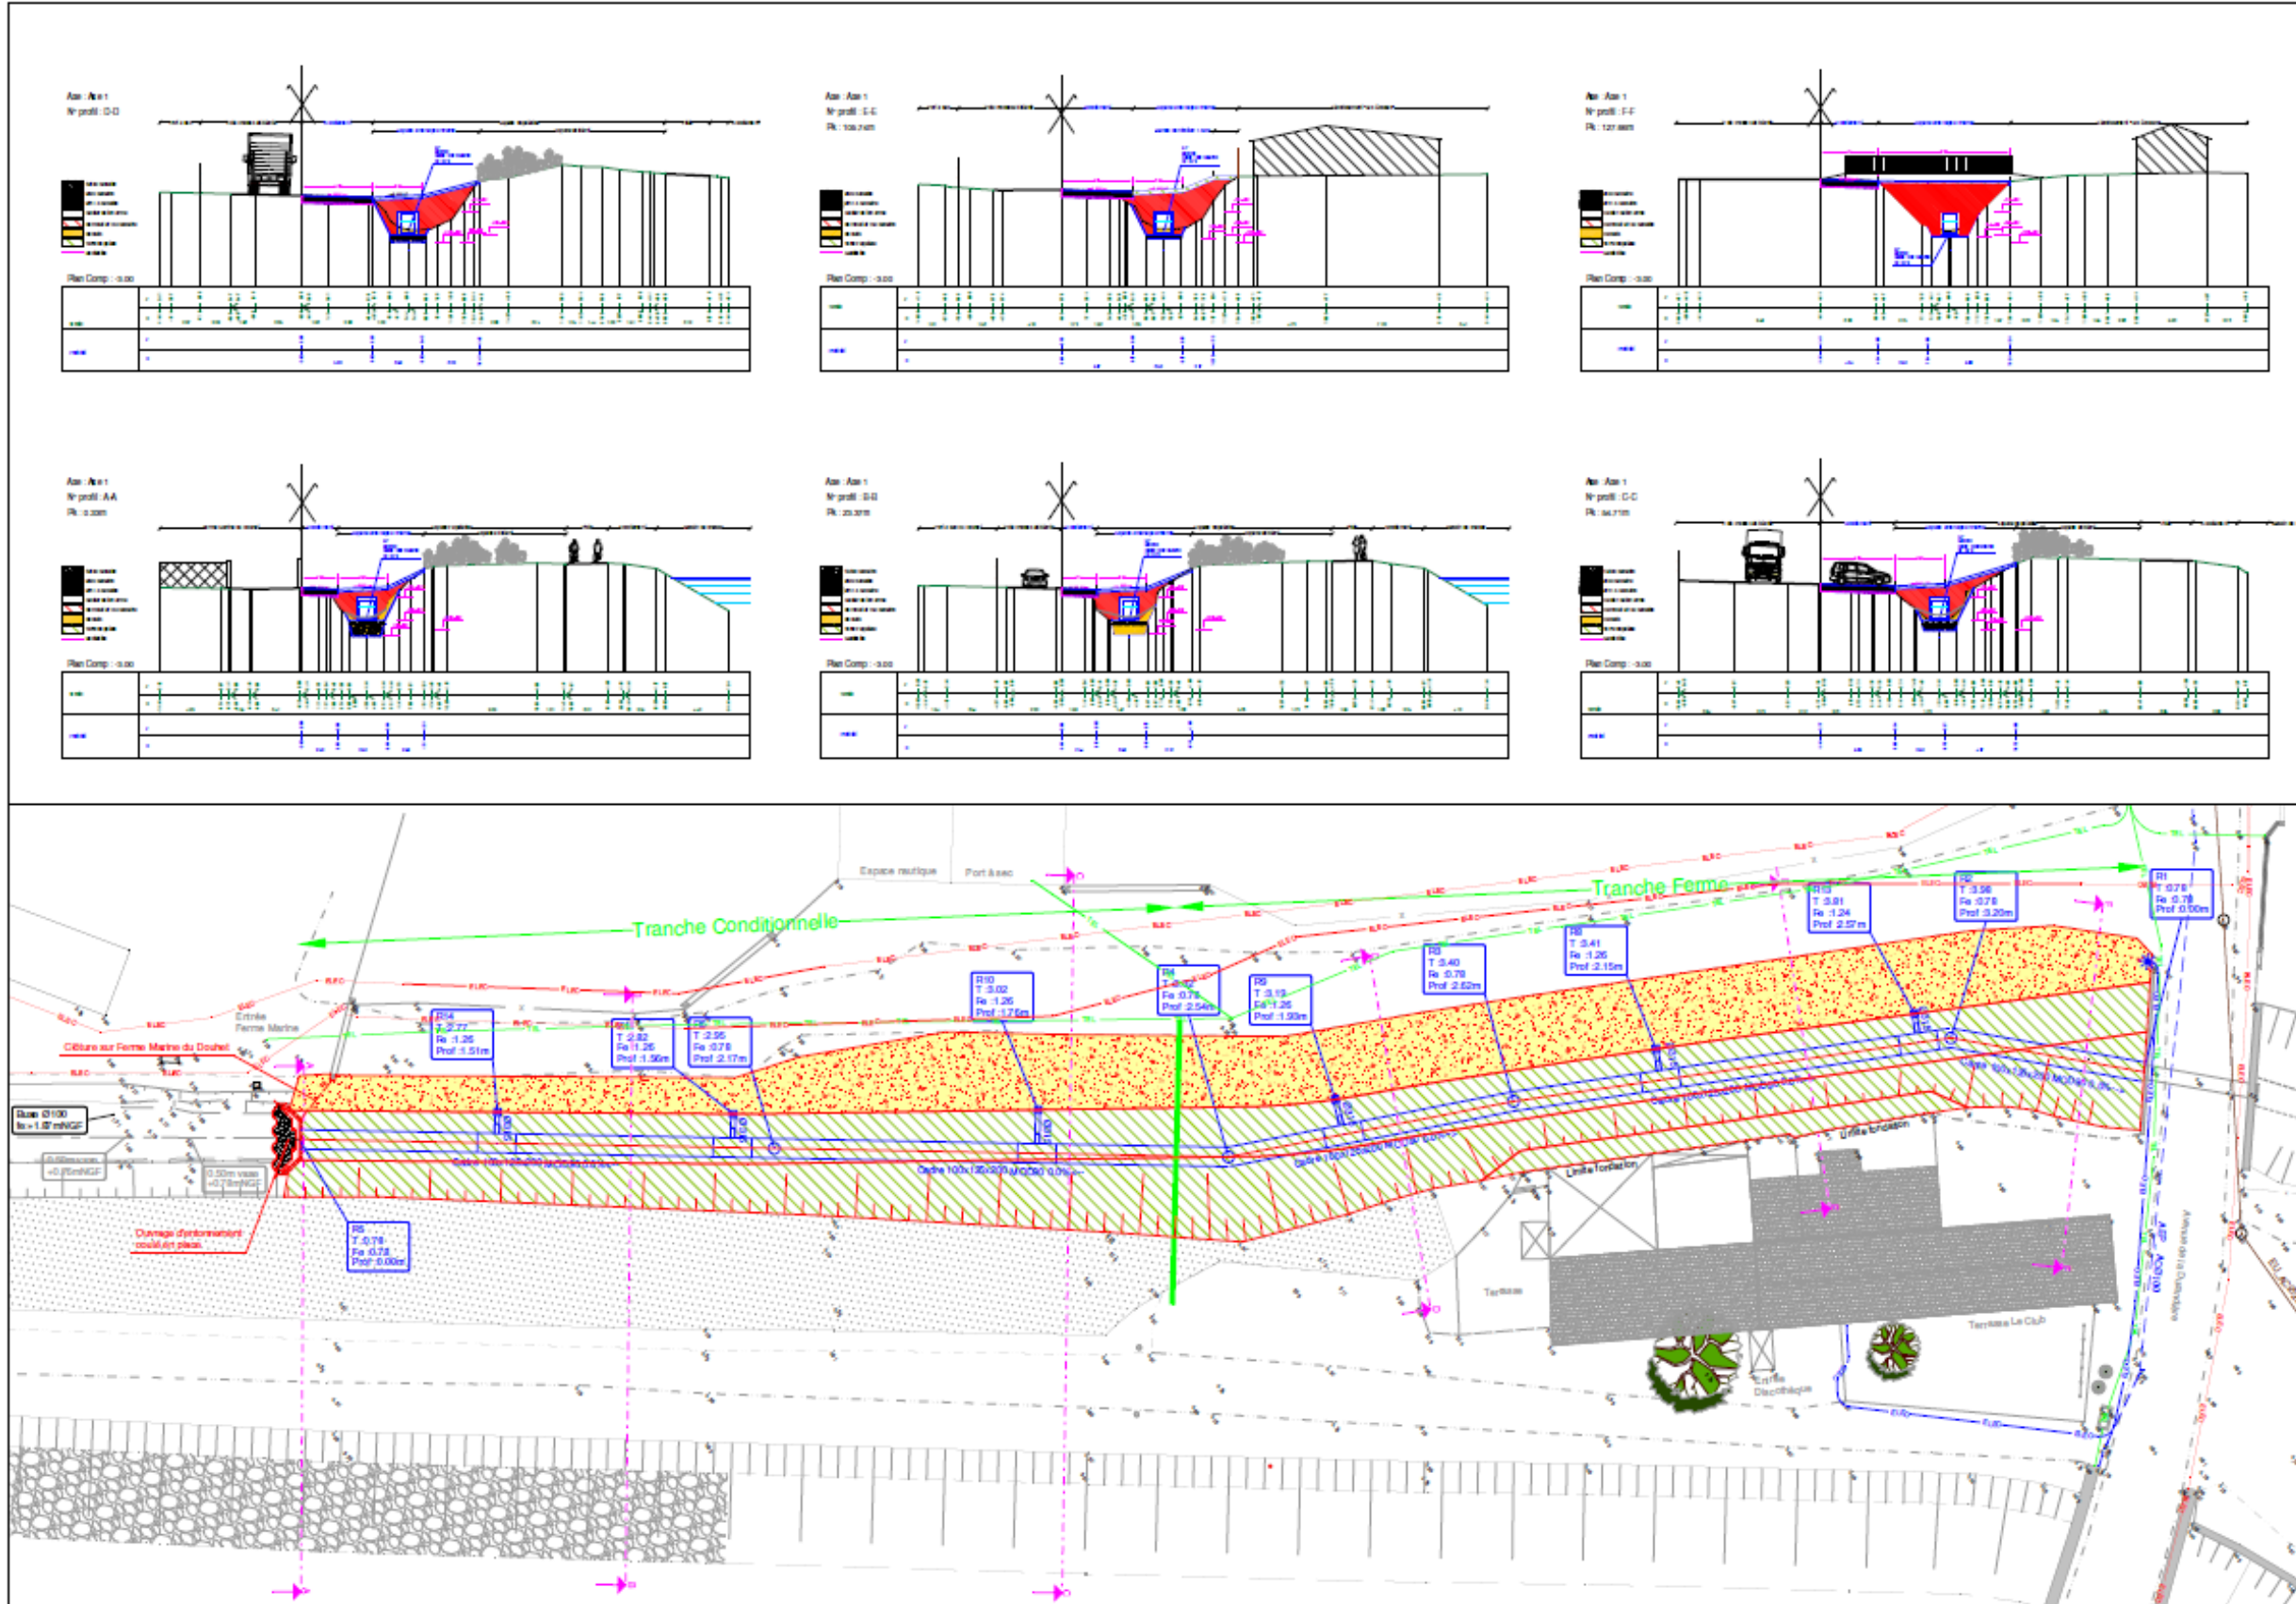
plan et coupes du projet de confortement des berges – Plan PRO
